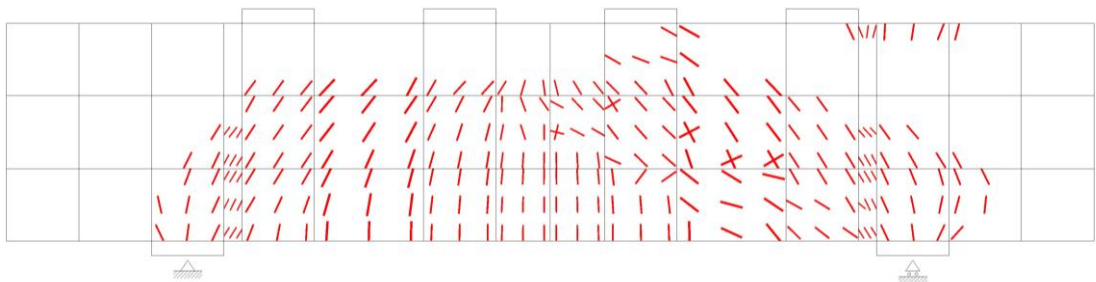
破壊時の変形及びひび割れ状態 (Case No. 11)
